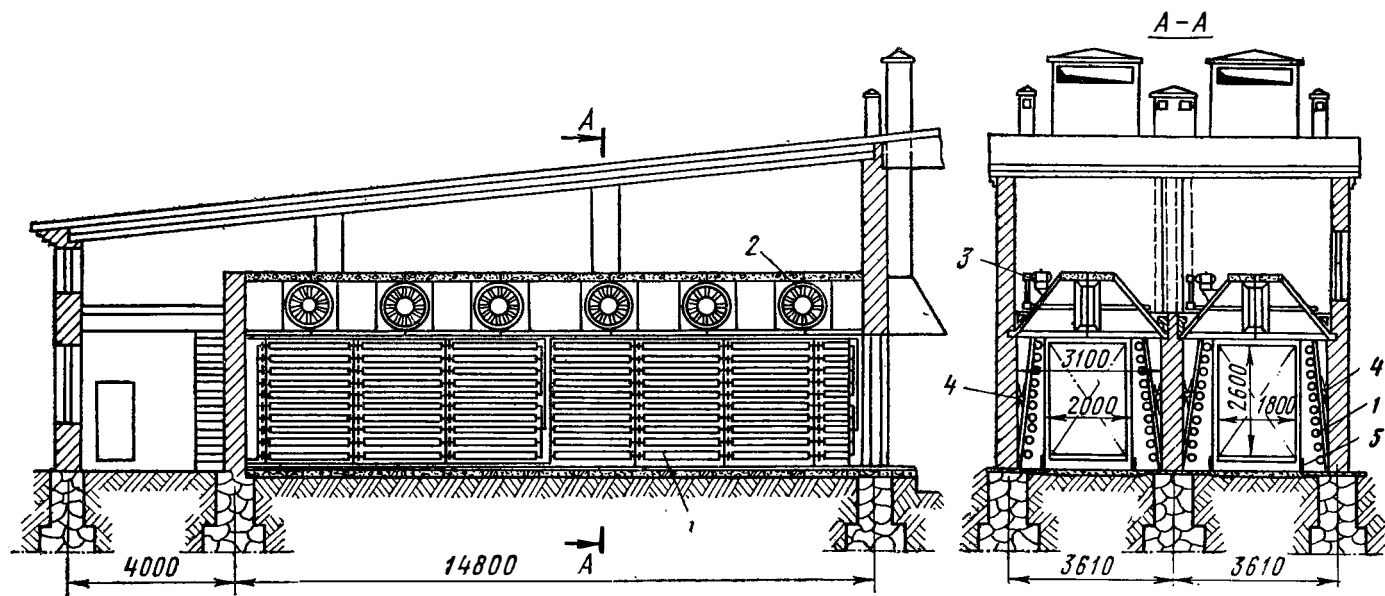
Сушильная камера с осевыми реверсивными вентиляторами на поперечных валах и трапециевидным перекрытием:
